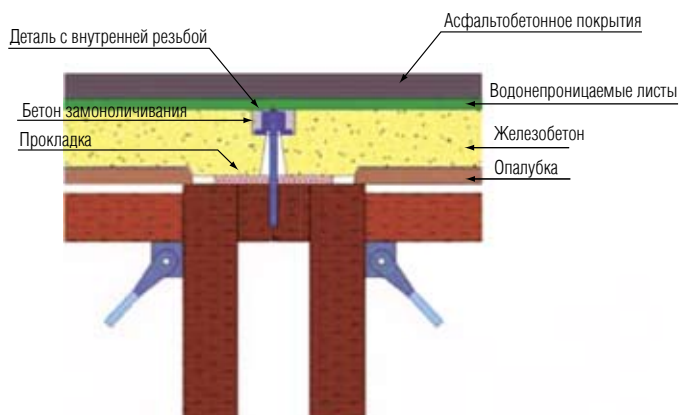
Узел сопряжения железобетонной плиты проезжей части с деревянными балками пролетного строения
